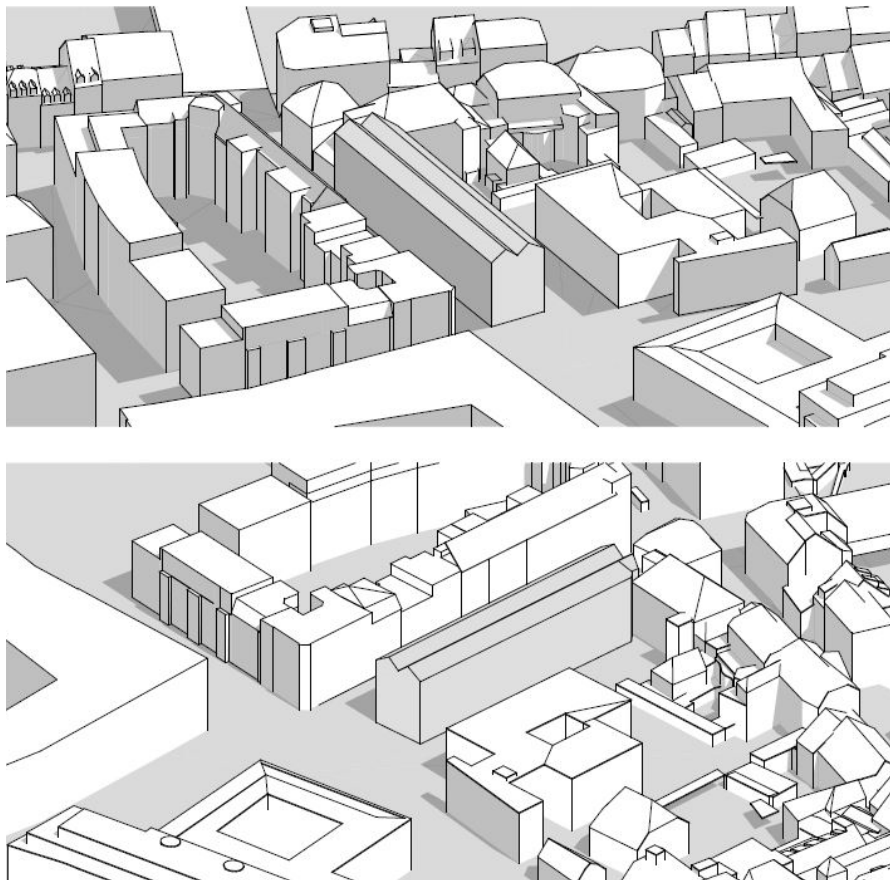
D-Modell, Baufeld Etappe 1 mit einzusetzendem Neubau Kopfbau BRCCH in Situation IST Schanzenstrasse 7-13 (Einsatz Modellgrundlage)
